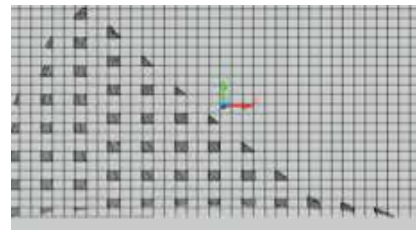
Imagen vista en planta primera mitad de una sección de velaría, en cortes horizontales como verticales.
